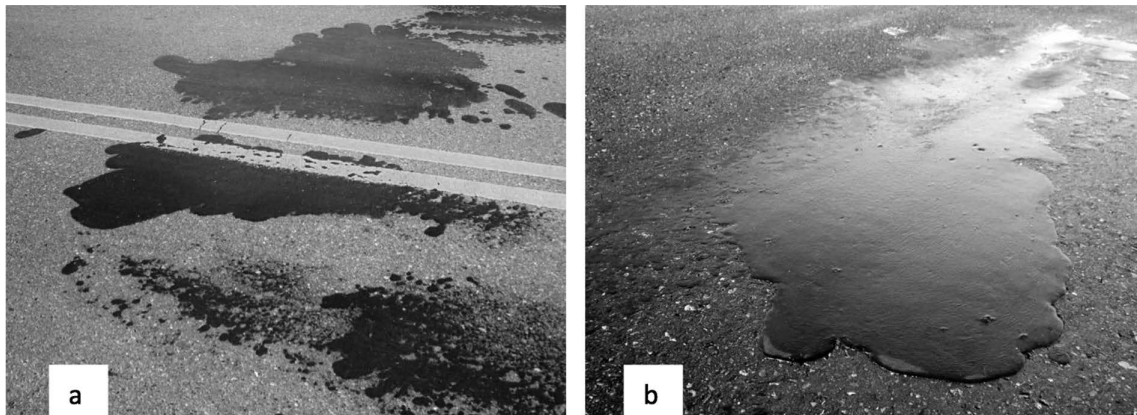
Manchas por exudación de mástico asfáltico: a) vista general; b) detalle de sector muy exudado
